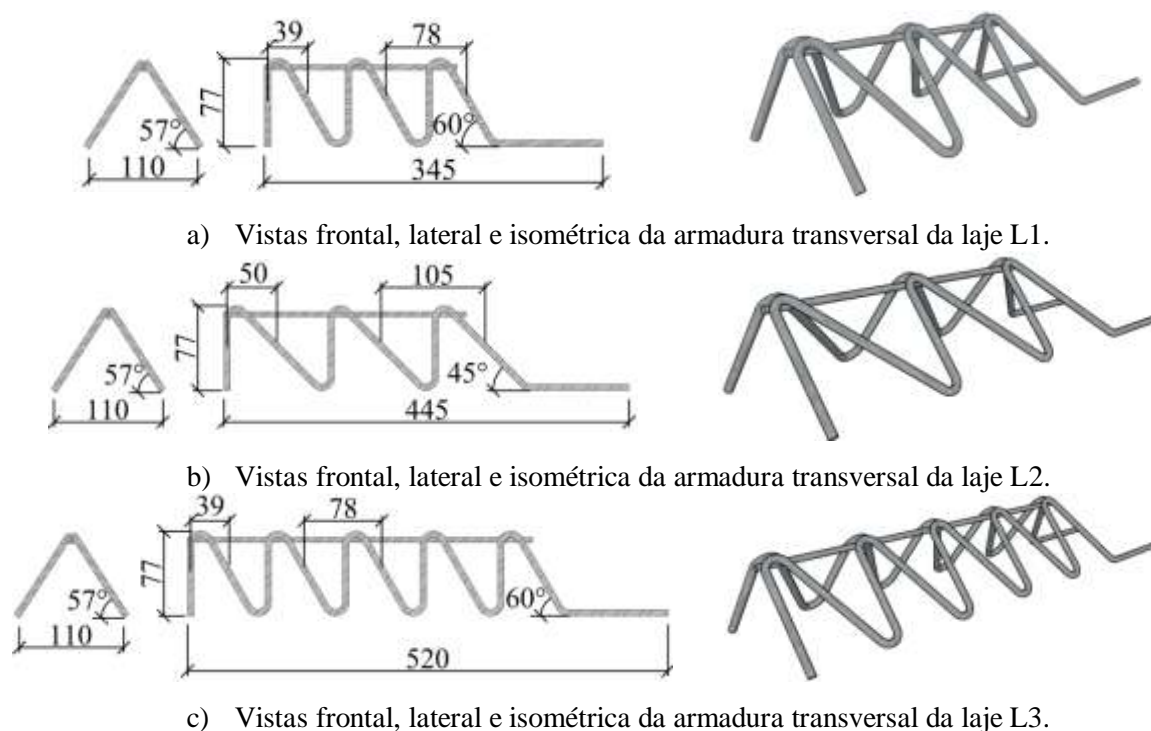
Detalhes geométricos das armaduras transversais aplicadas nas lajes
